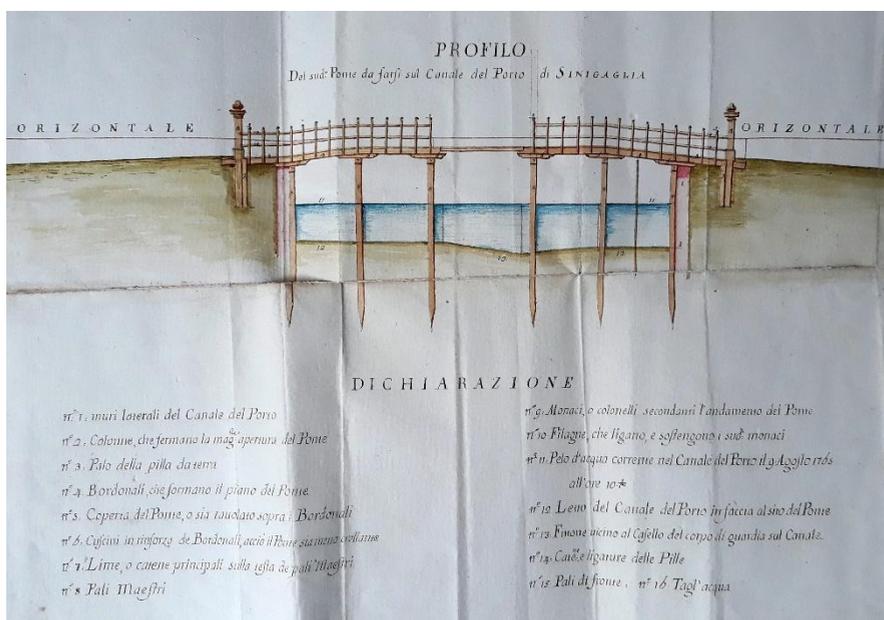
Ponte levatoio progettato dall'arch. Guarini nel 1765
